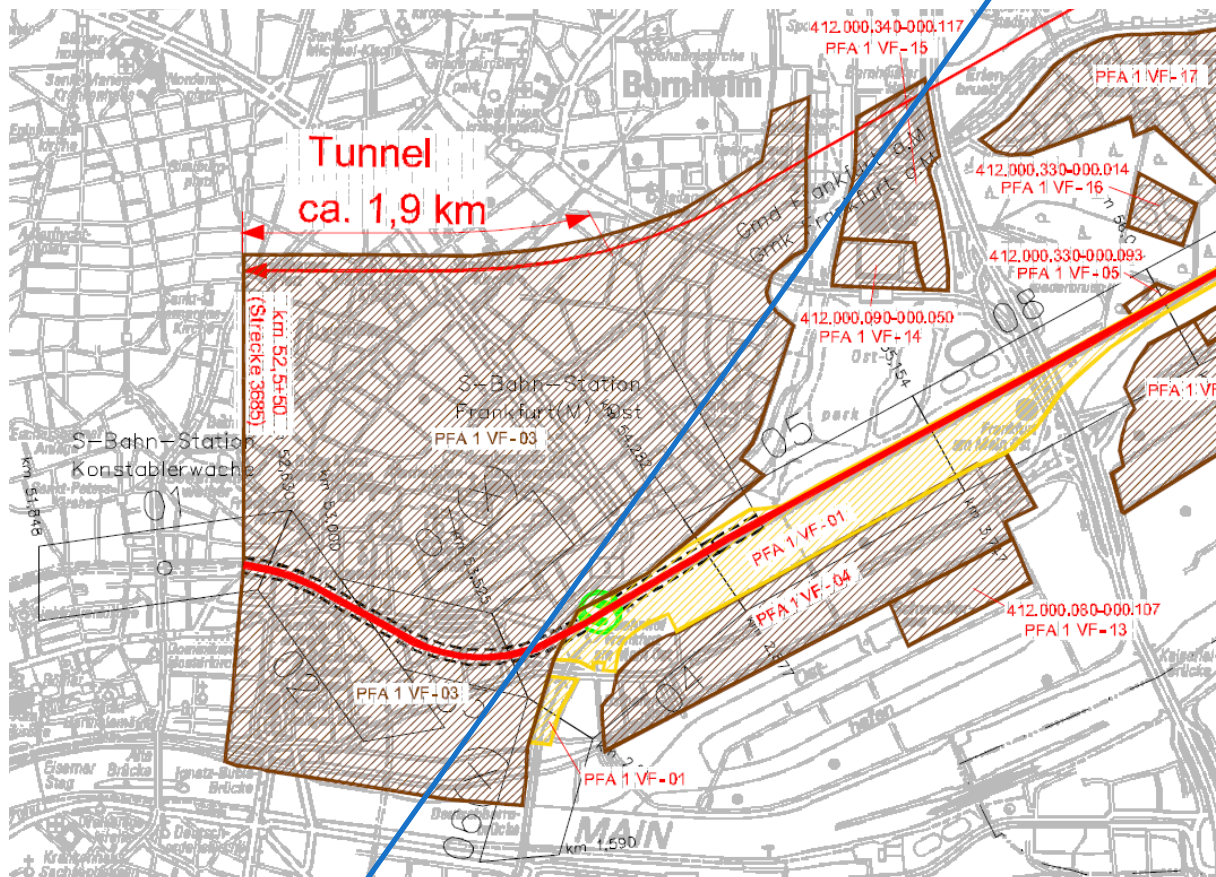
Ausschnitt Übersichtslageplan Verdachtsflächen
